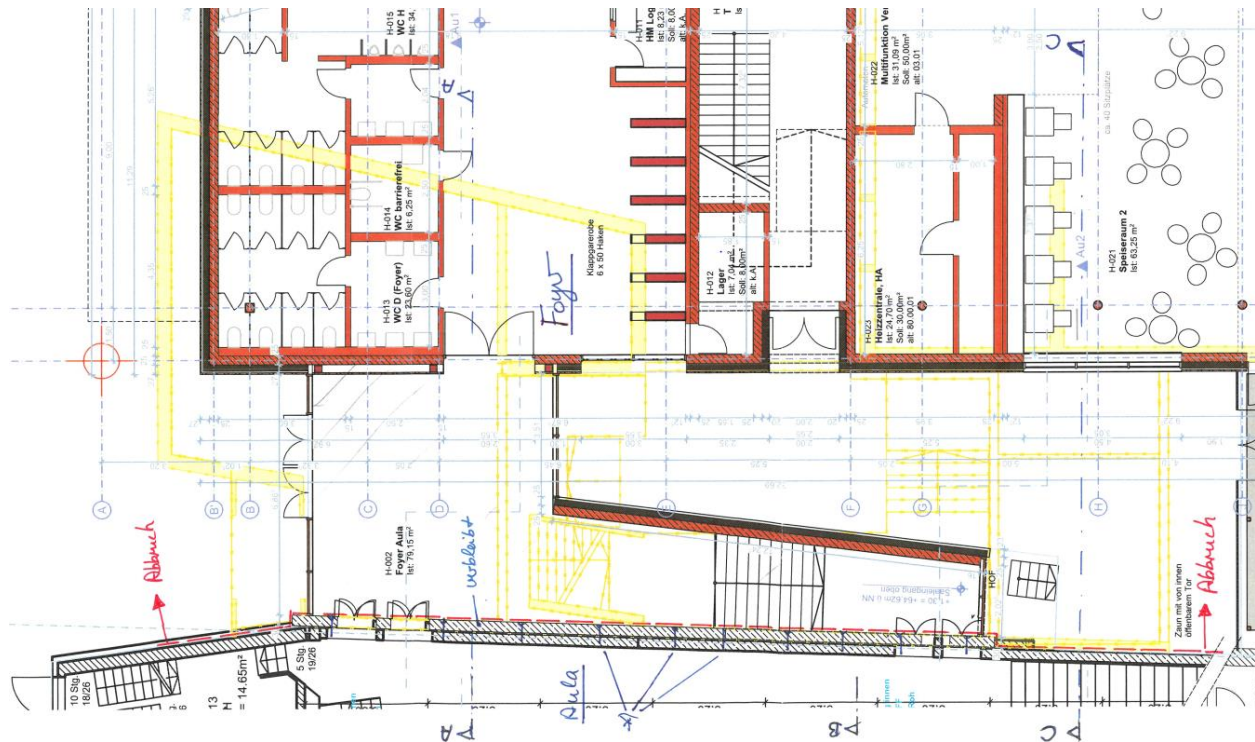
Grundriss des Aulafoyers - Detail Abbruchgrenze
